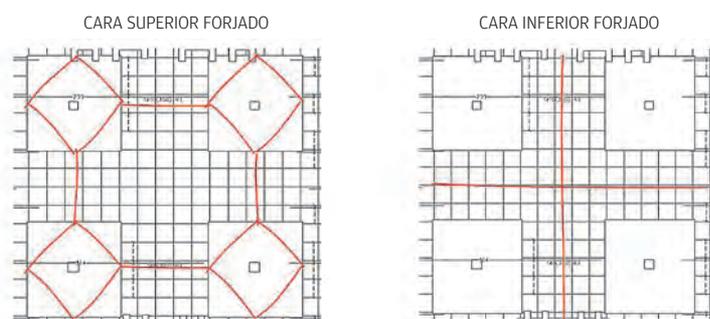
fisuraciones en forjado reticular por exceso de flexión.
